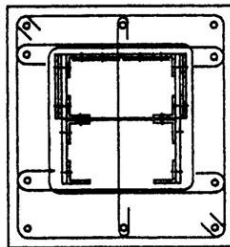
Consolidación de pilar mediante camisa de hormigón armado
